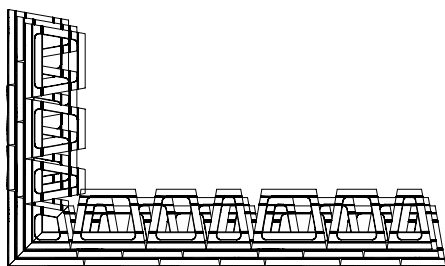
Grundriss Aussenecke mit Rücksprung 5,5 cm
